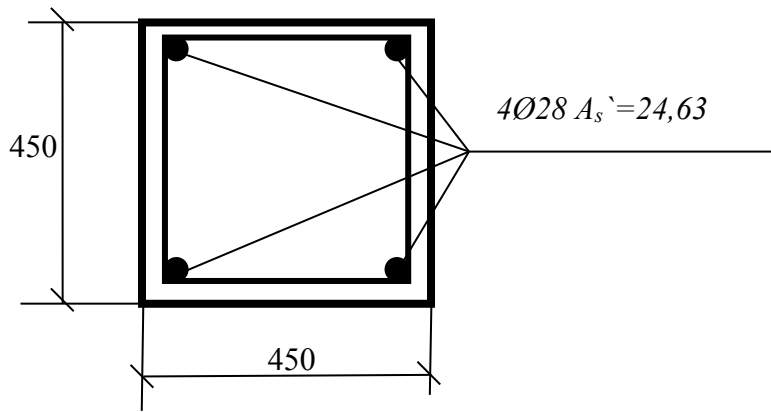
Поперечний переріз колони, яку підсилюють
